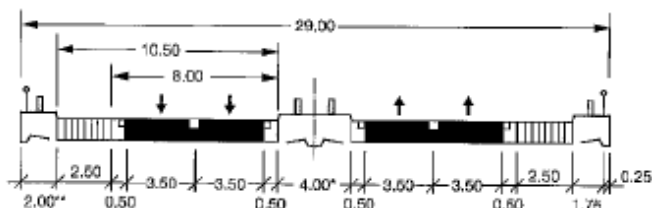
Przekroje poprzeczne stosowane w tunelach na autostradach w Niemczech.
